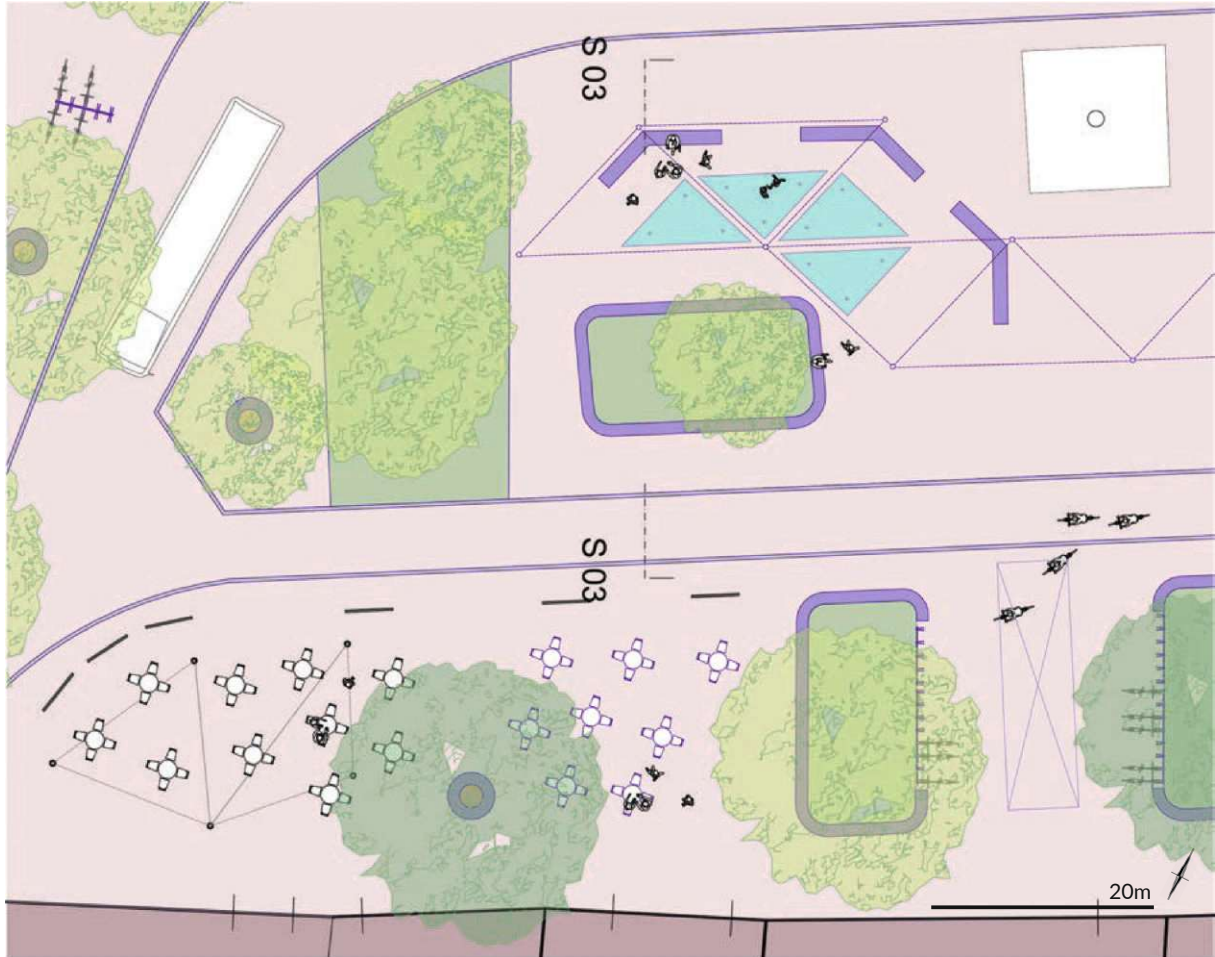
Grundrissausschnitt Wasserspiel, eigene Darstellung
